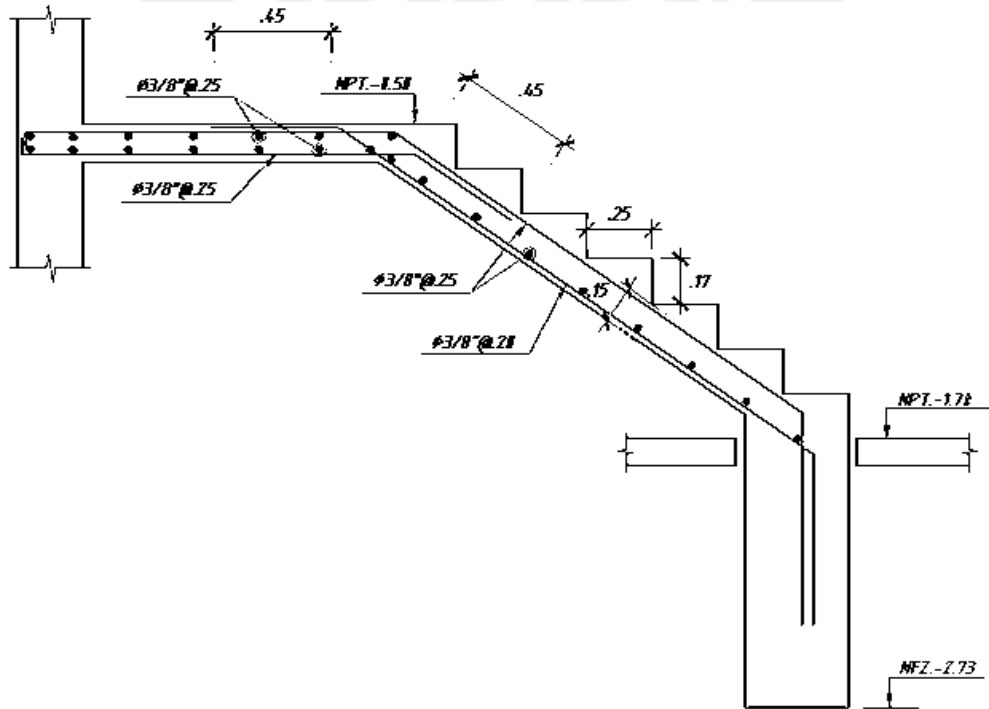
Esquema del armado final para la escalera del ejemplo.
